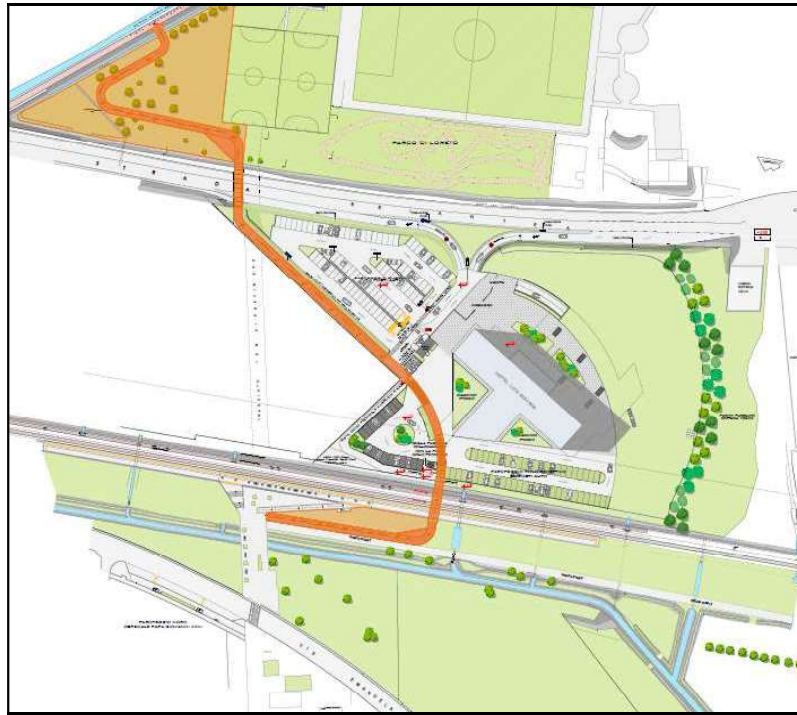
planimetria di progetto dell'AT_e14 – nuovo polo ricettivo
